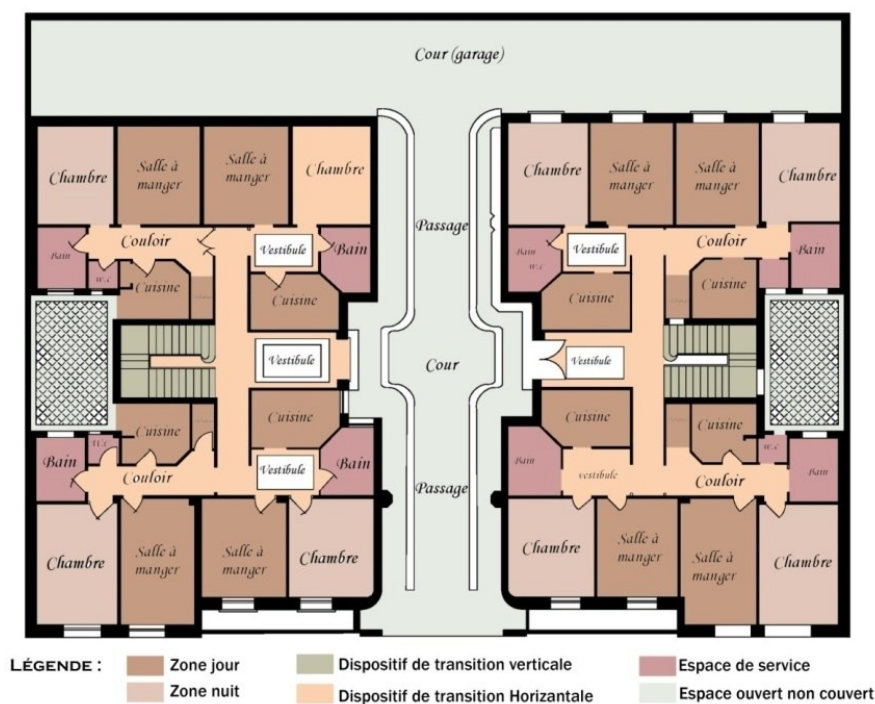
32-34 rue d'Arles, plan du rez-de-chaussée,
